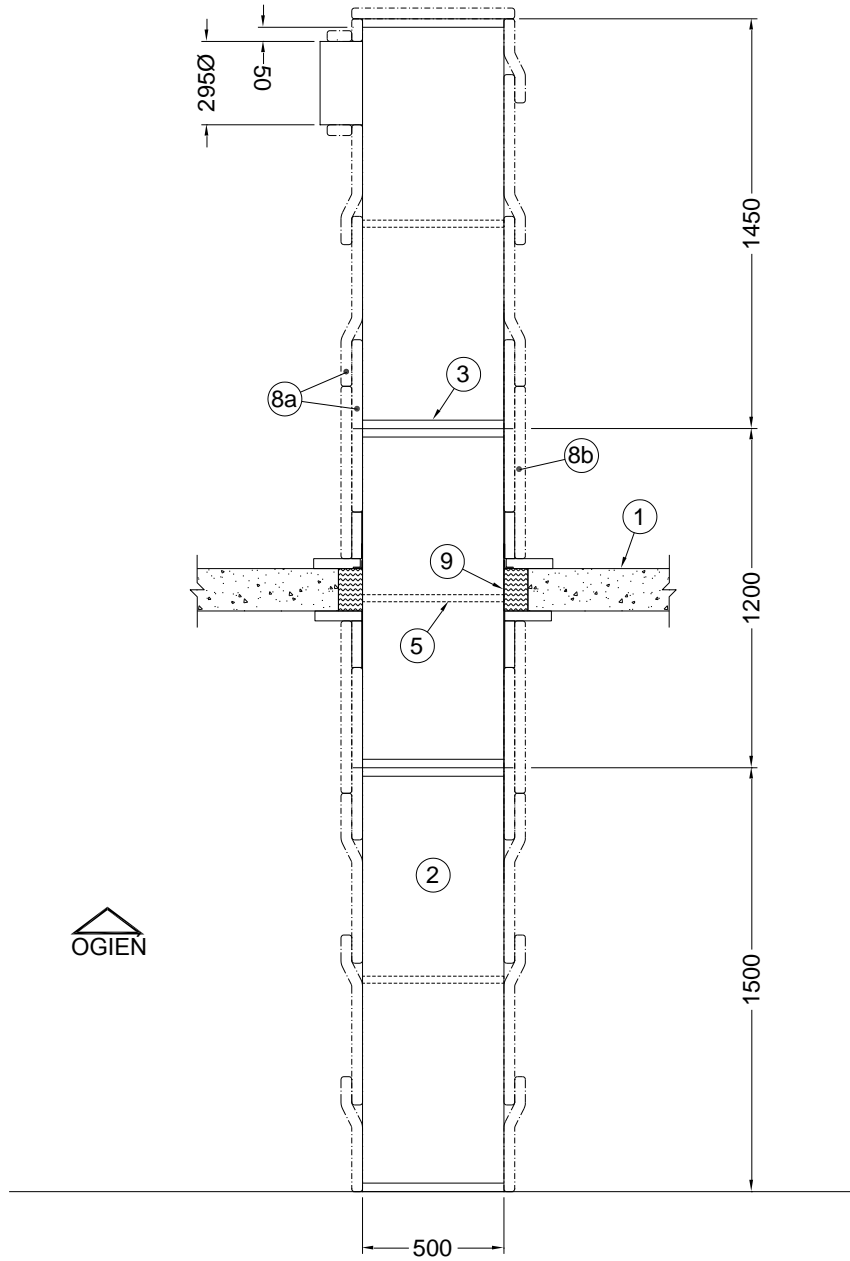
Typowy widok z przodu - zainstalowany zespół pionowy
